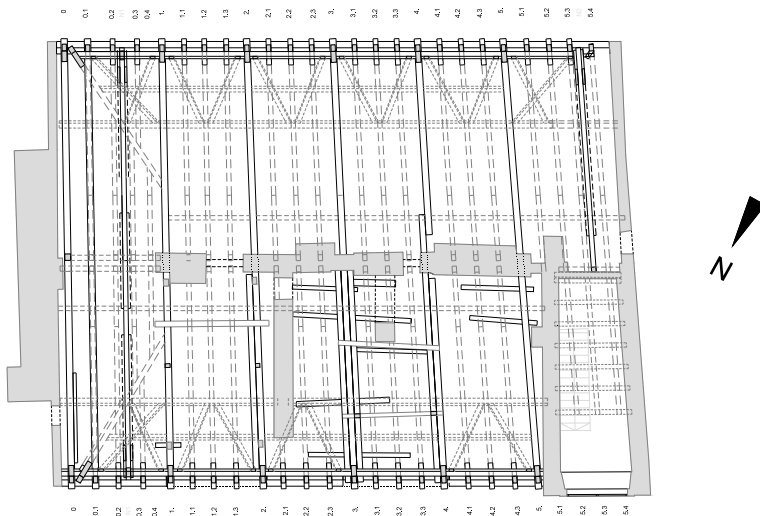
Lageplan Südostdachwerk des Schweizerhofs mit Markierung des SO-Trakts
